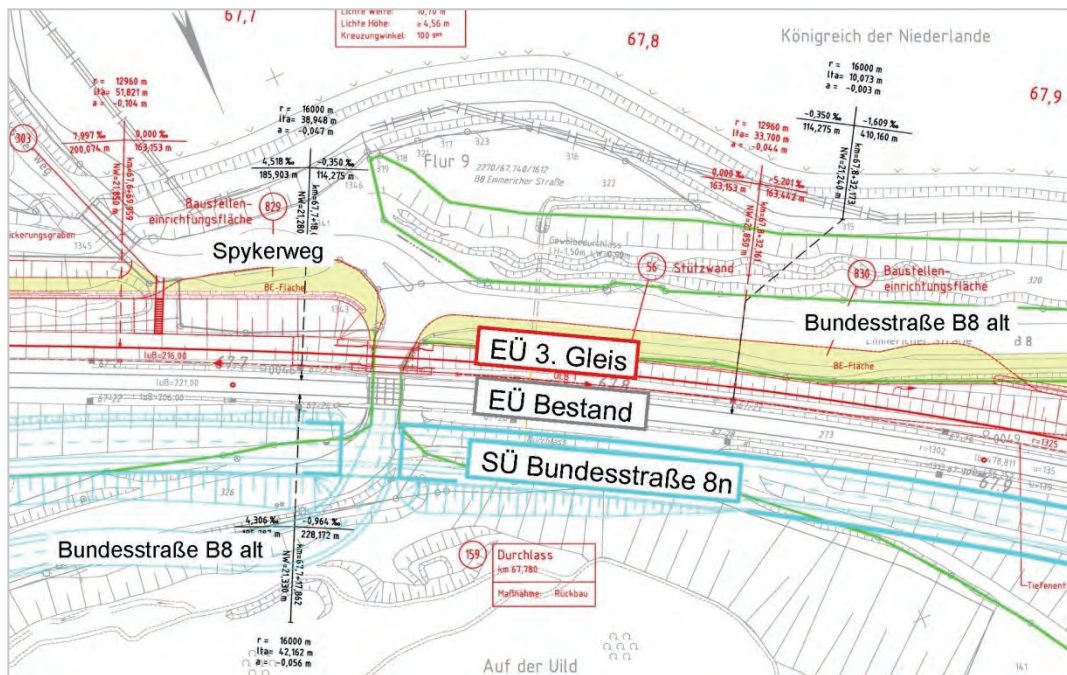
Lageplan DB AG / Lage der Bauwerke
